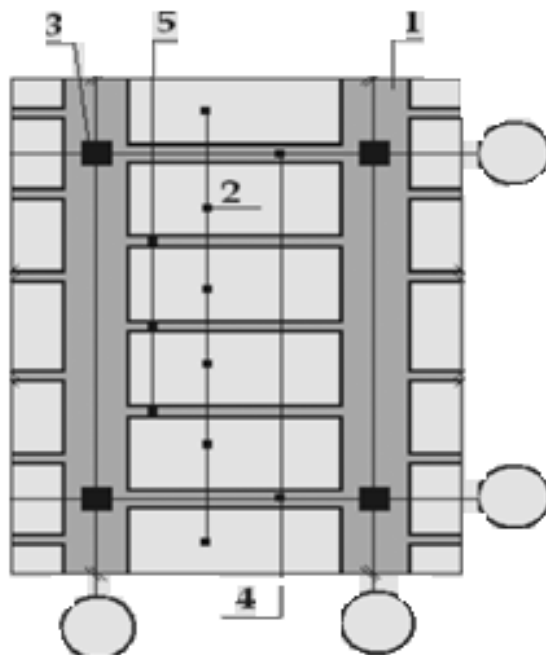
Стык горизонтальных и вертикальных несущих конструкций: 1 – монолитные ригели; 2 – сборные многопустотные плиты с открытыми пустотами; 3 – сборные железобетонные колонны; 4 – прикомонные монолитные балки; 5 – монолитные балки между плитами
